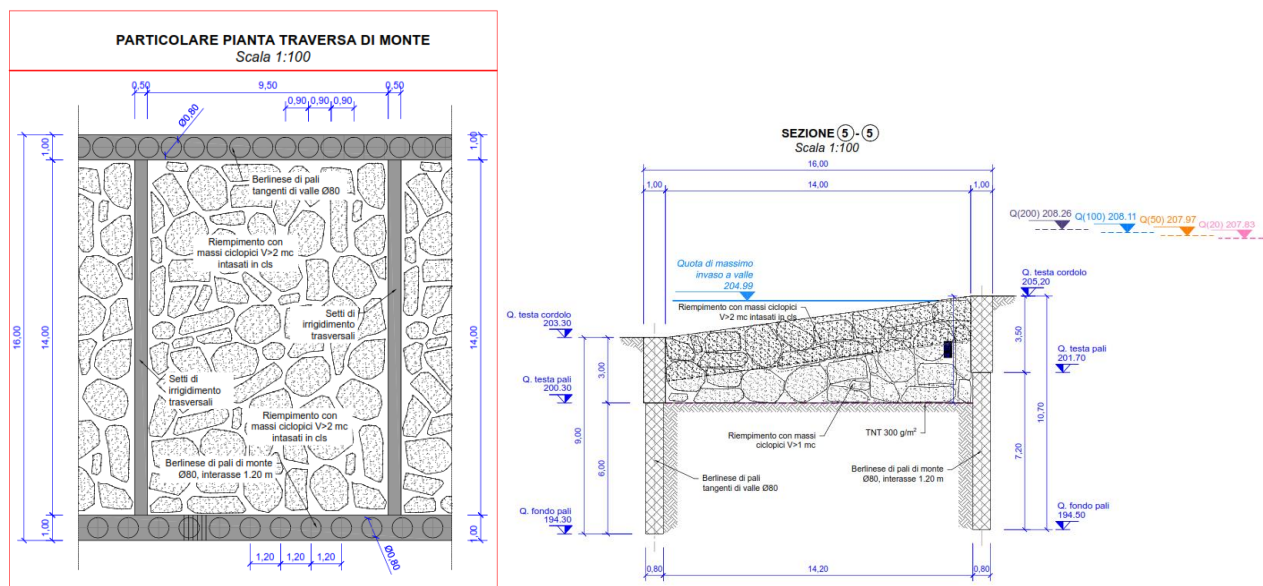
Planimetria e sezione tipologica della nuova soglia in progetto
